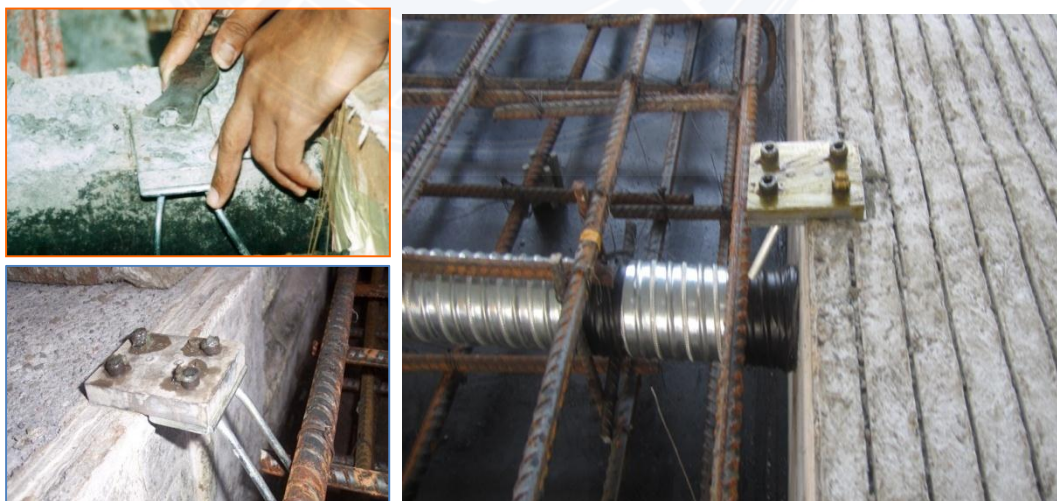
Rakitan Tulangan Box Girder Pada Rebar Cage
